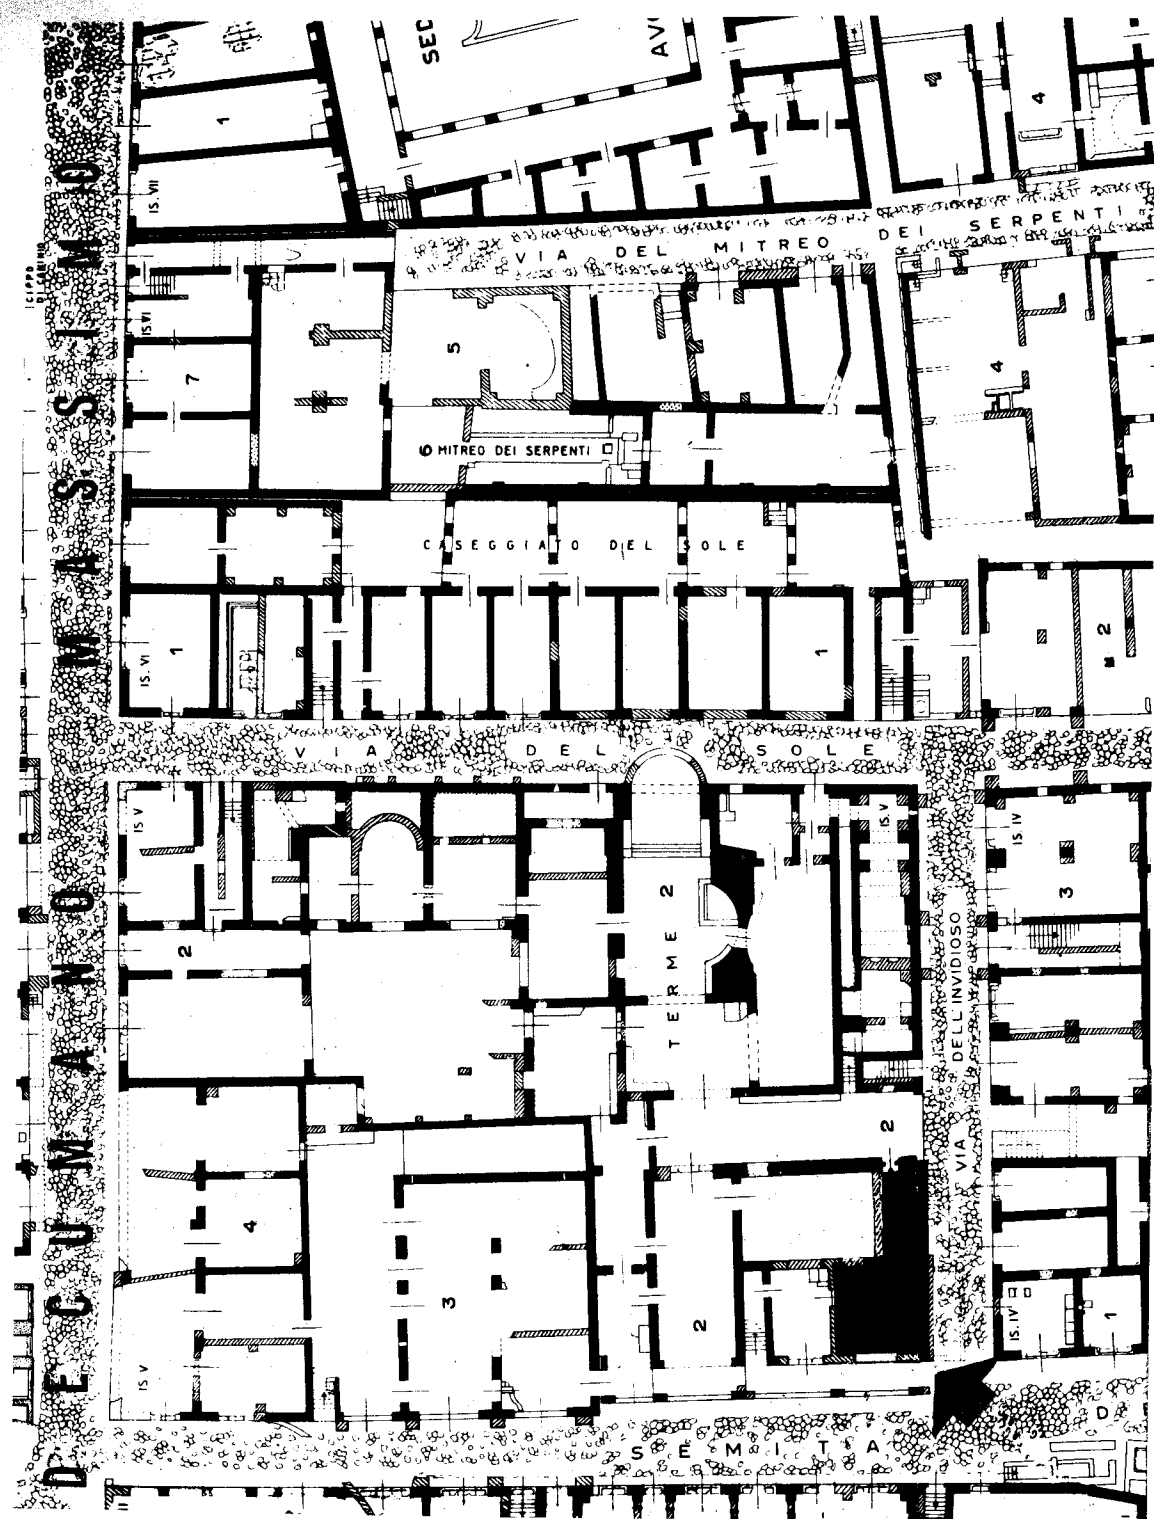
Planimetria della zona con indicazione della taberna (1:500).
